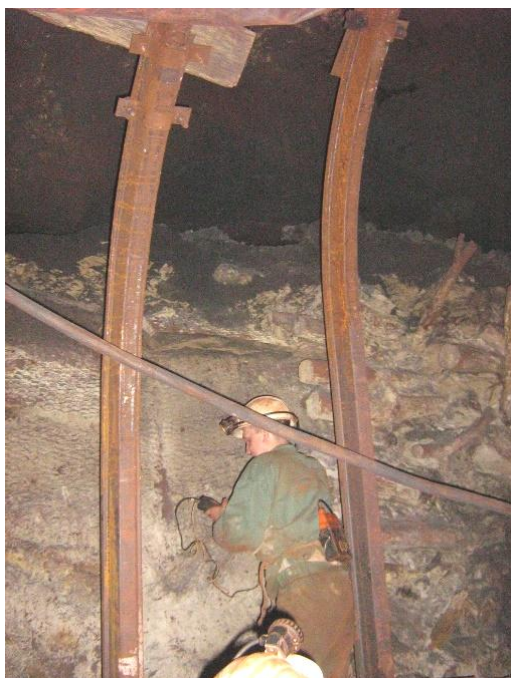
Пустоты над бетоном в кровле заходки №22, вид с заходки №23
